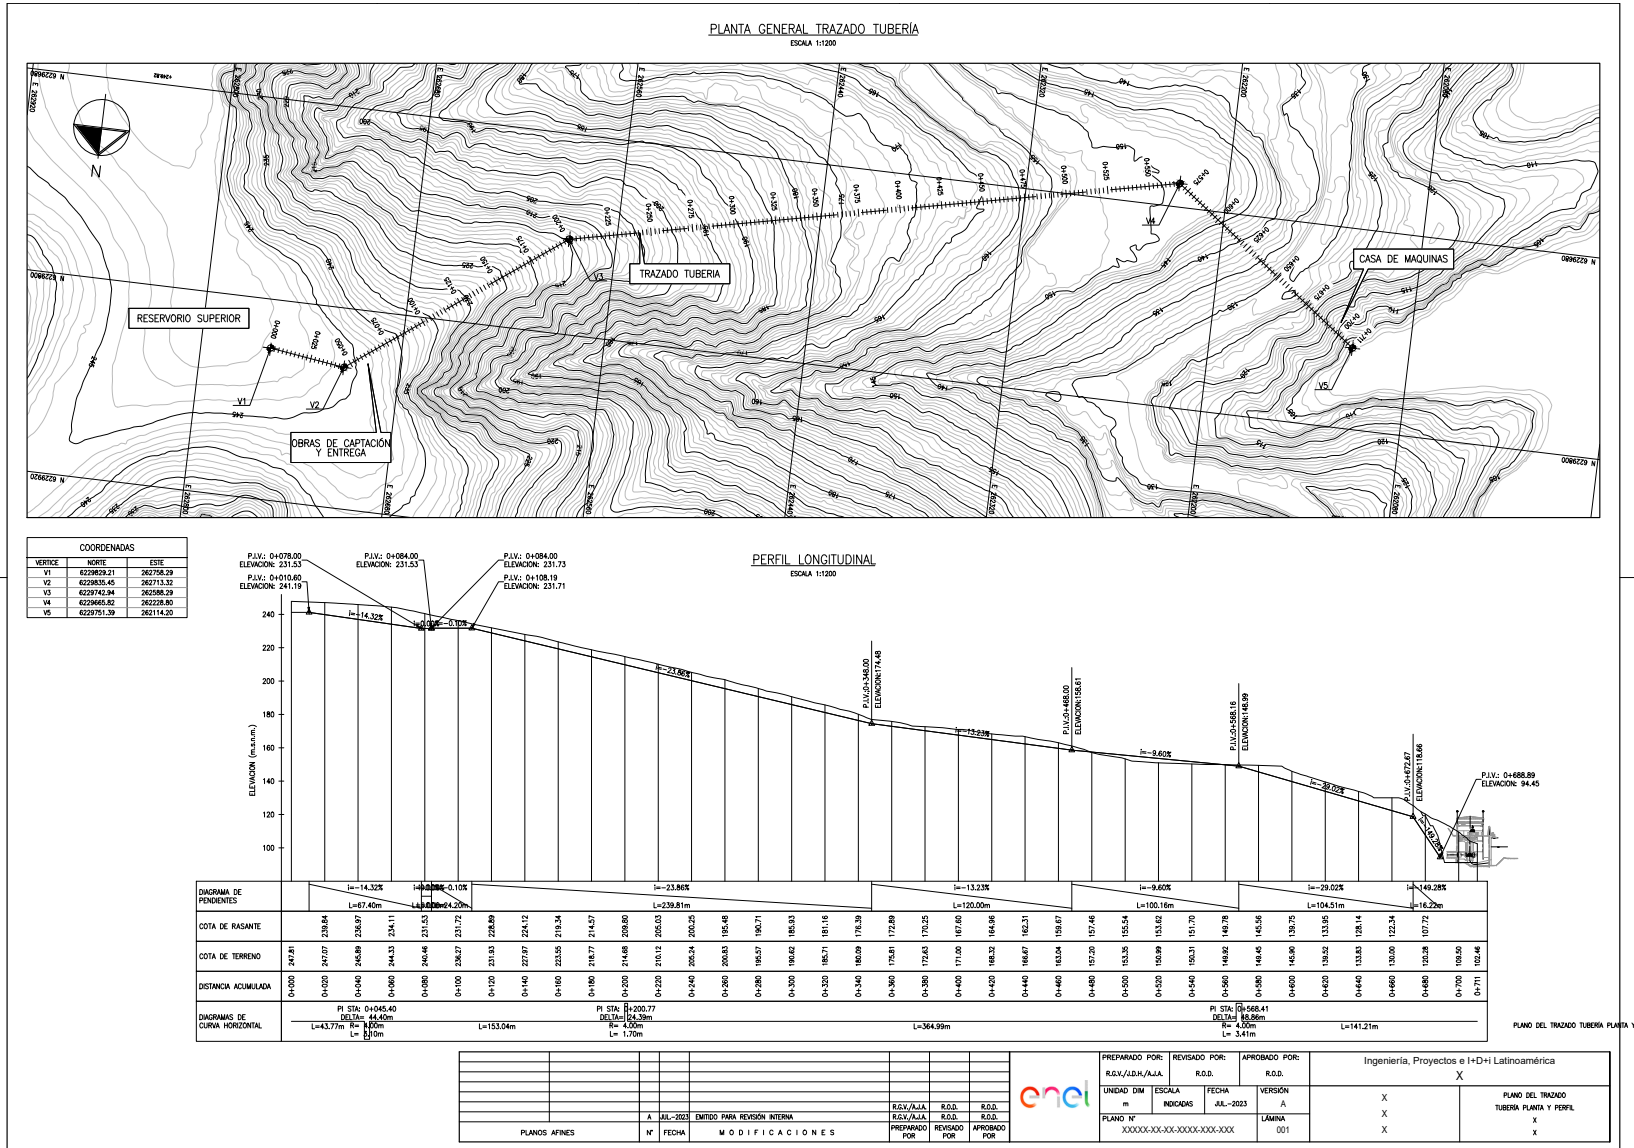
Plano general trazado tubería. Fuente: Guzmán Vargas, R.
